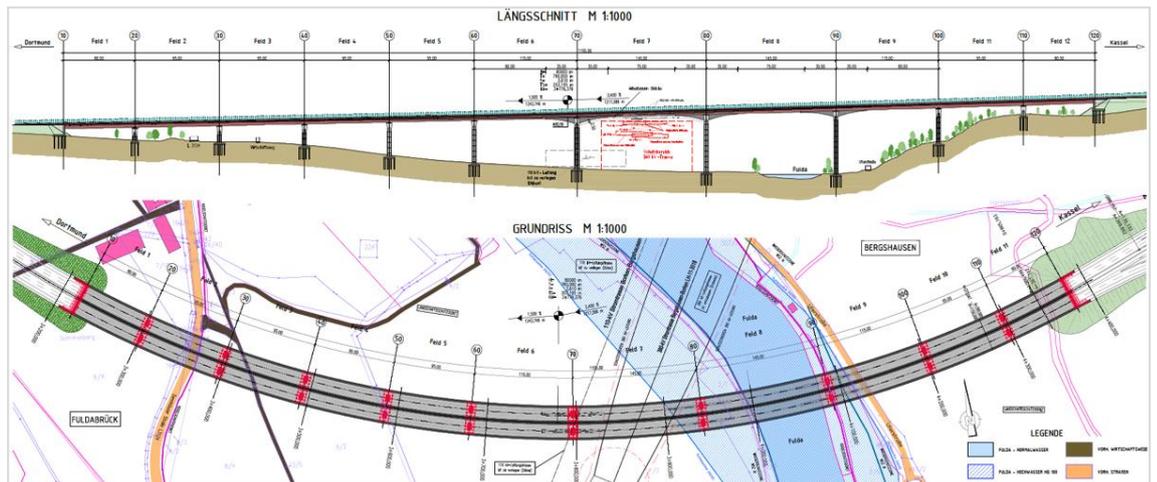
Längsschnitt und Grundriss der geplanten Bergshäuser Brücke (BW 07) in Variante 3 (Quelle: SCHÜBLER-PLAN 2019A)
